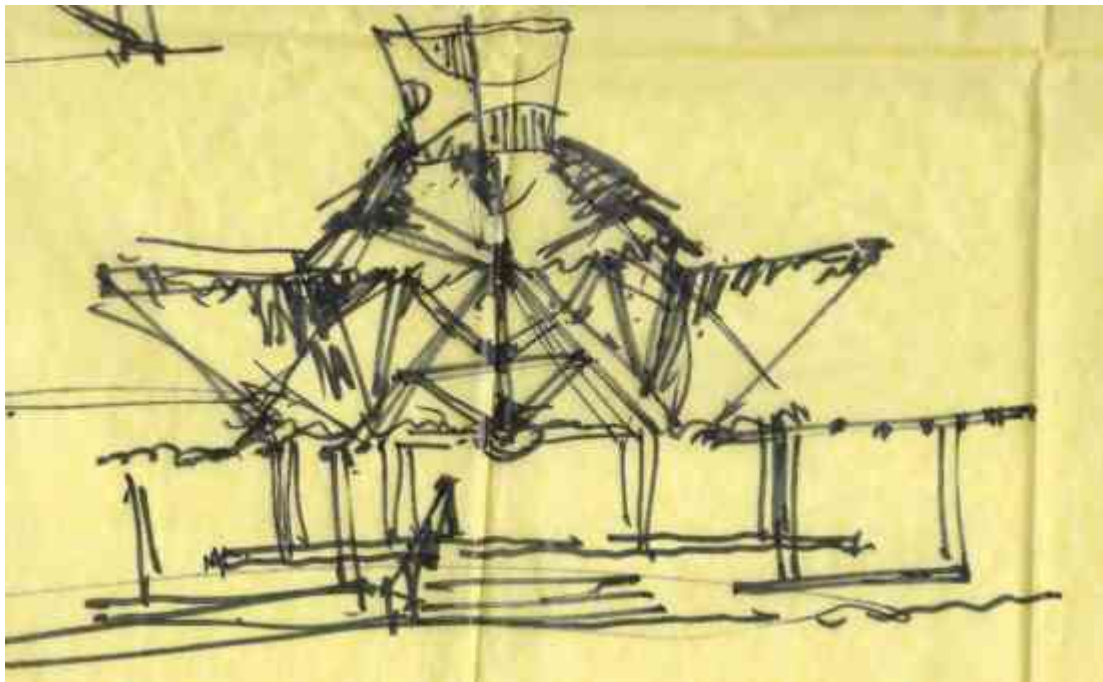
Conceptualización en Alzado de Restaurante Bar Zamá.
